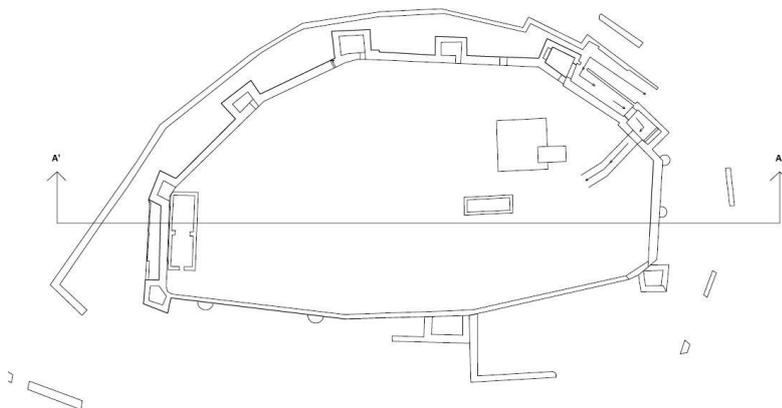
Plano en planta que nos indica el corte de las secciones-hipótesis realizadas.
